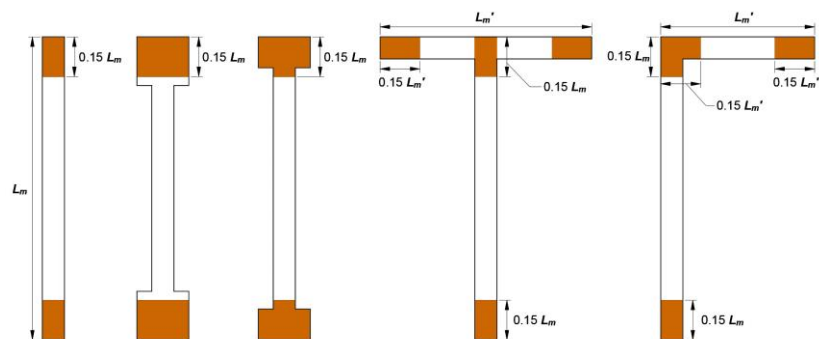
b – Ubicación del refuerzo longitudinal en el borde de muros requerido en 8.7.3.2.4.a (adaptada de ACI CODE-318-19)
